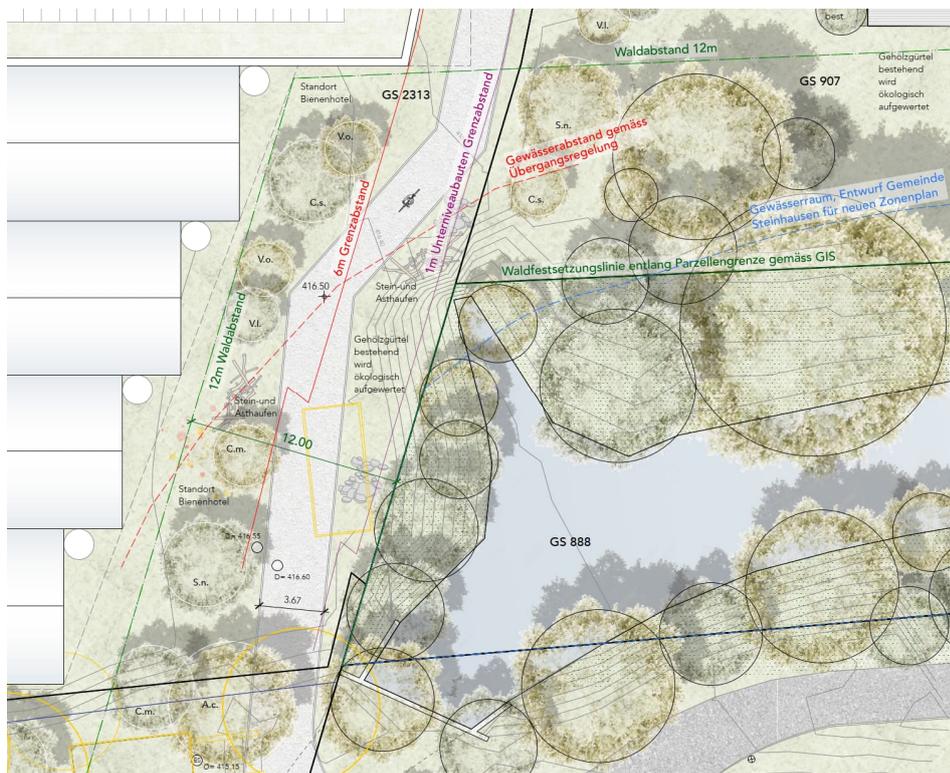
Gewässer- und Waldabstände (iten landschaftsarchitekten gmbh, 2023)
